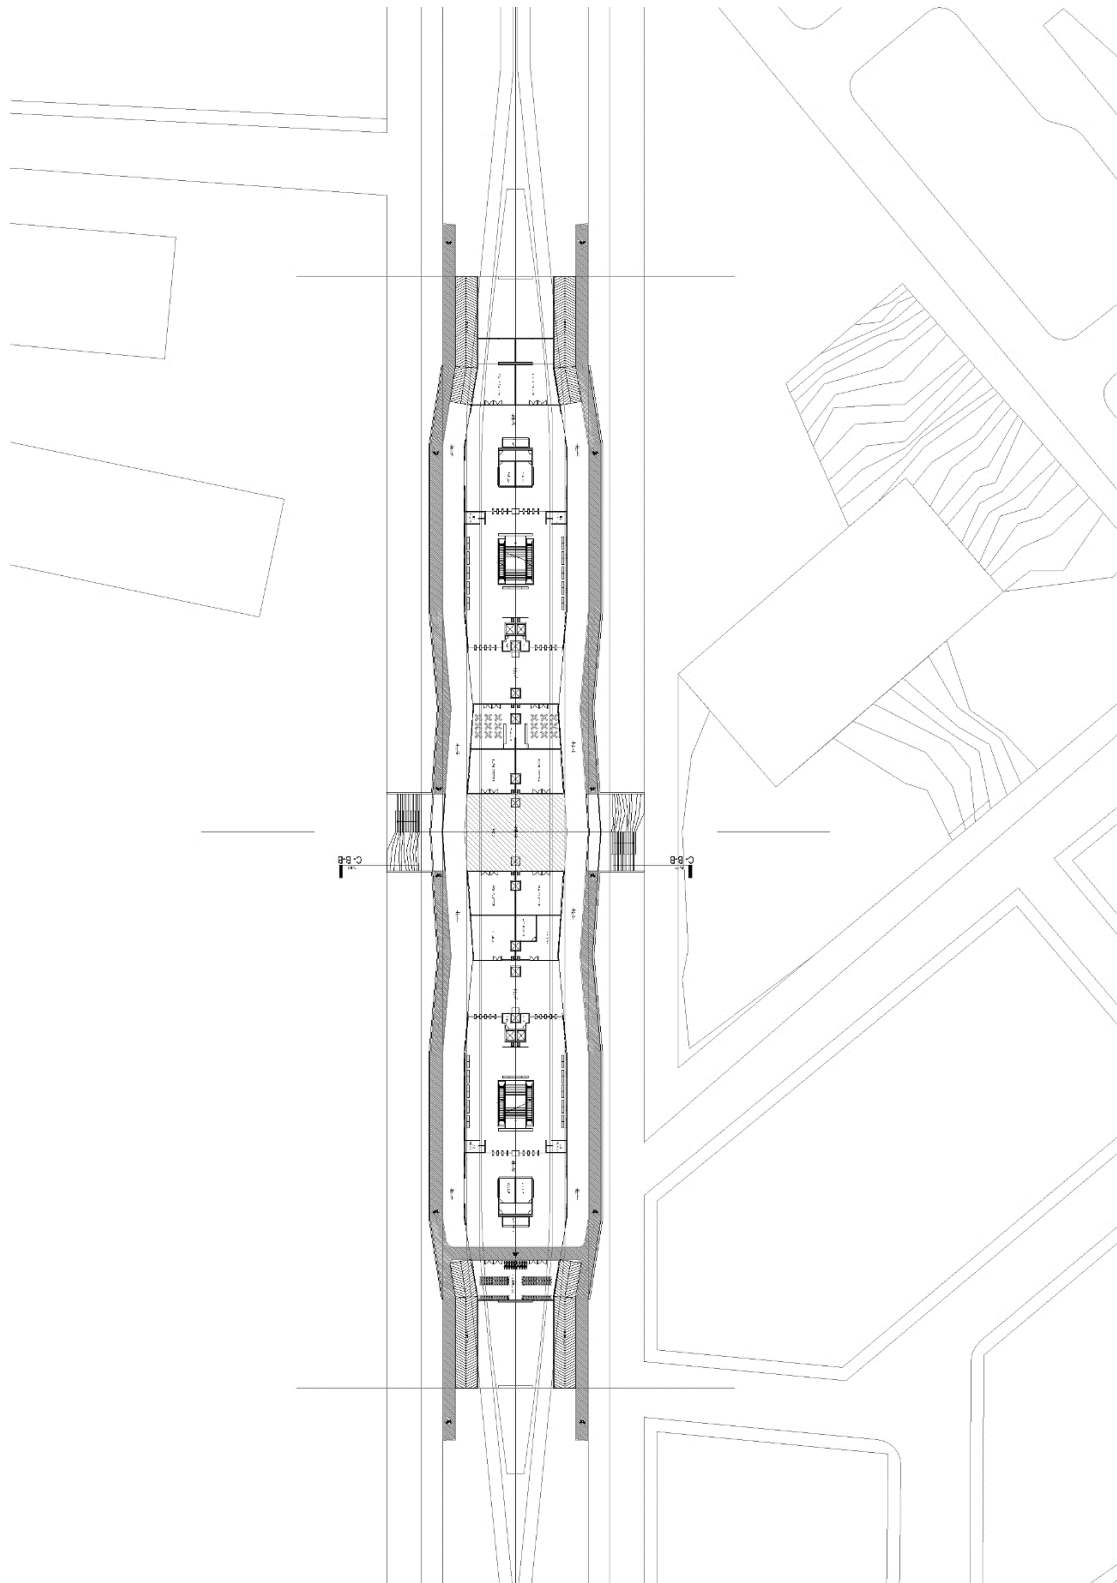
Plano de propuesta Integral – Imagen Propia
